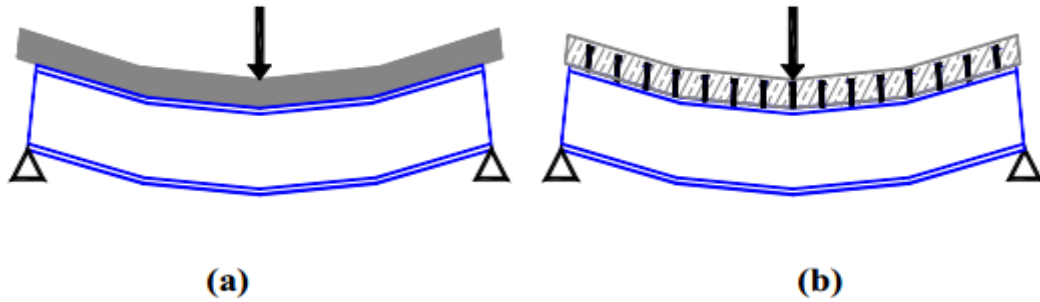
(a): Poutre non mixte, (b): et poutre mixte [3].
